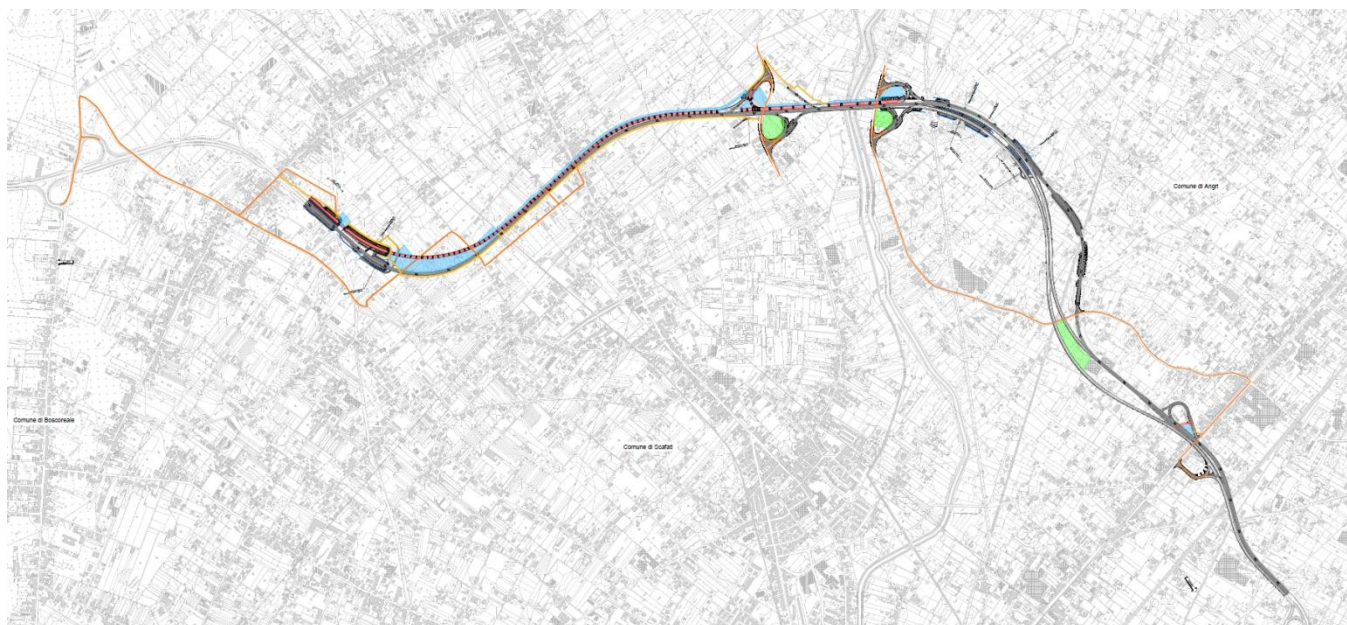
Planimetria attività di cantiere Lotto 2 – Fase 1
